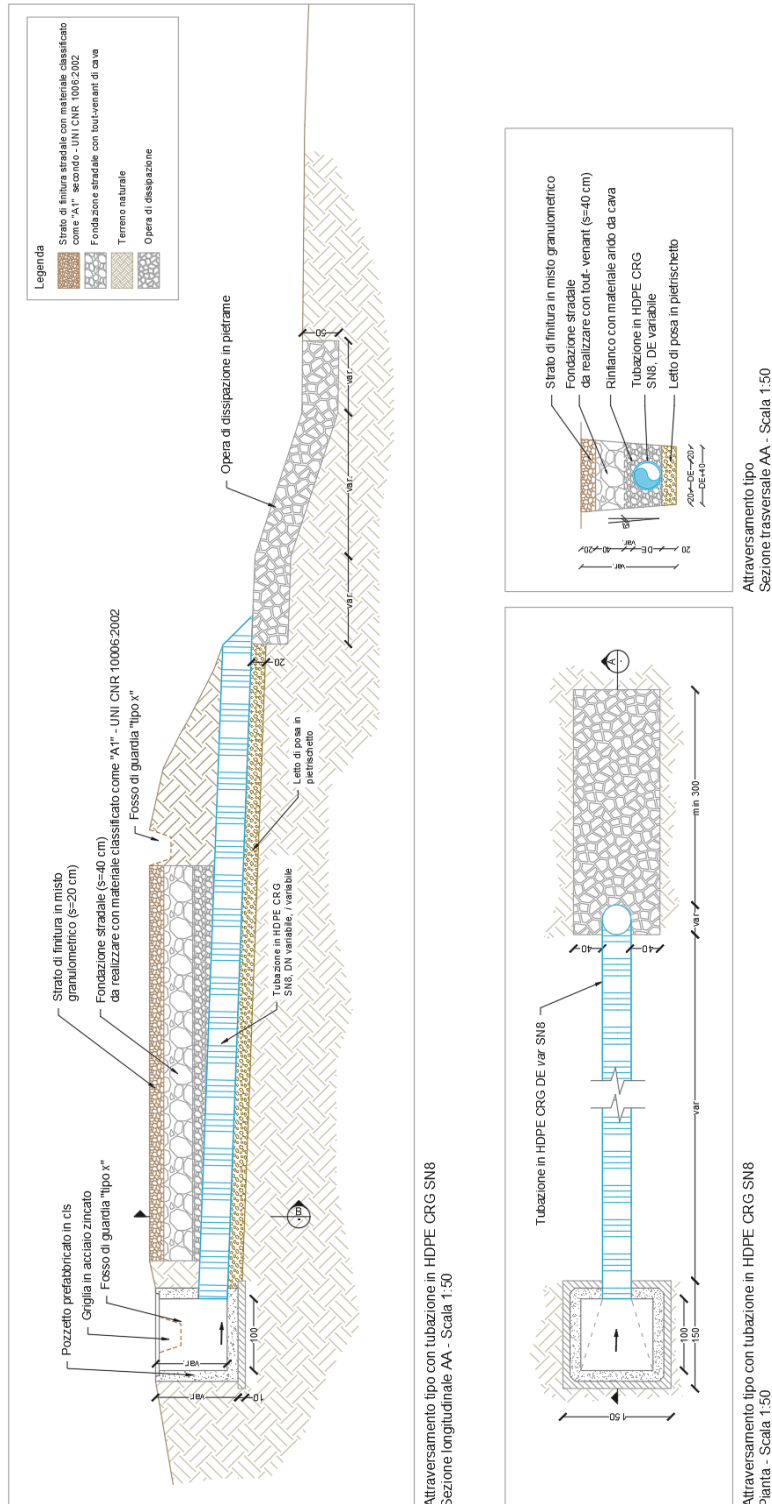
Sezioni longitudinali, trasversali e pianta dell'attraversamento tipo.
